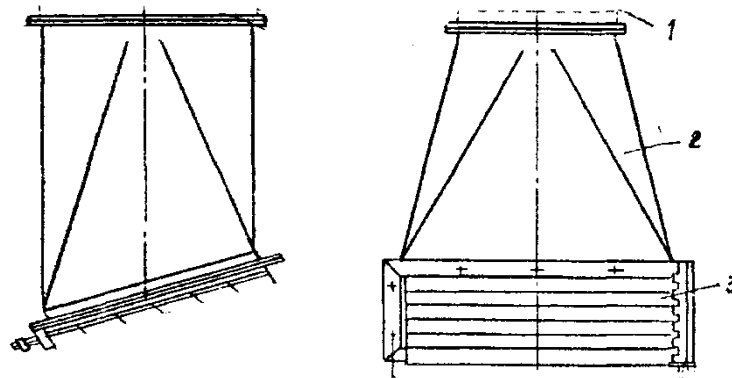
Душевой патрубок с верхним подводом воздуха типа ПДВ: 1 - воздуховод; 2 - корпус; 3 - направляющая решетка
